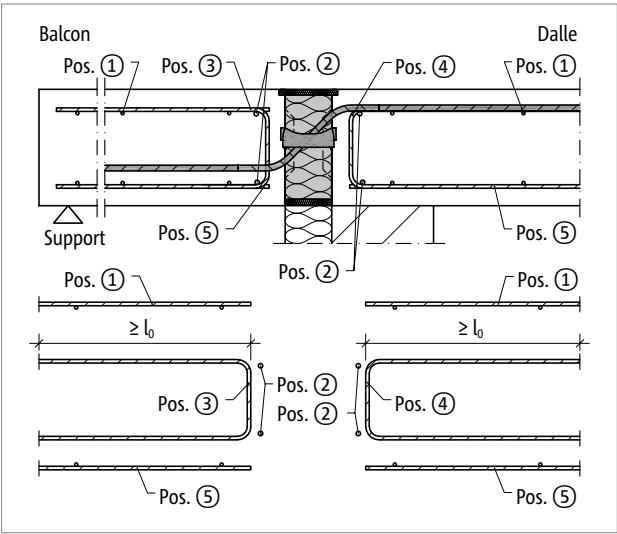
Schöck Isokorb® T Type Q-E-V : Renforcement sur site
